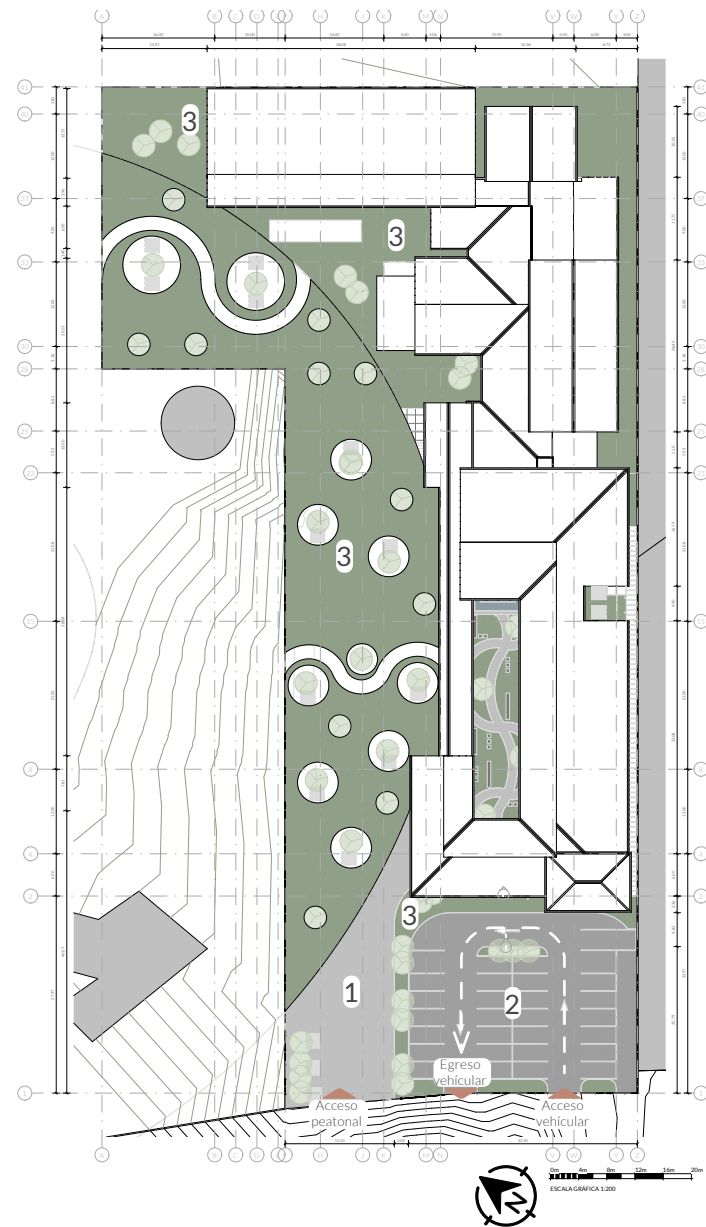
Planta de conjunto del IAP. Elaboración propia.
